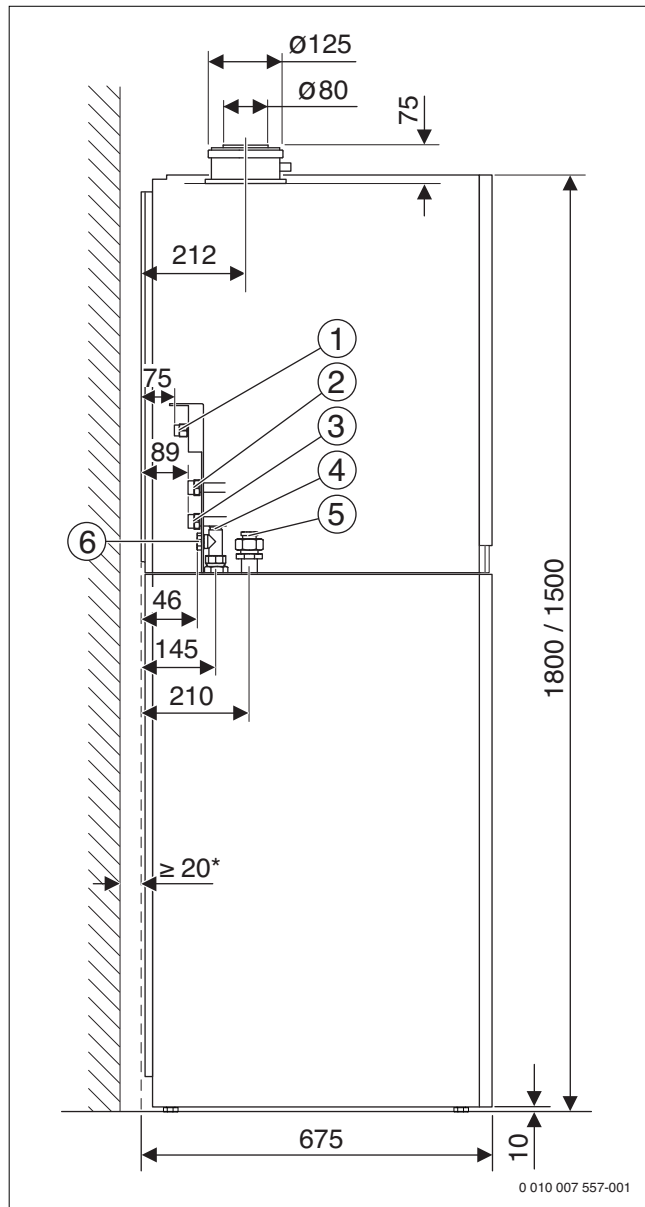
Dimensions et raccords sans accessoires (en mm)
